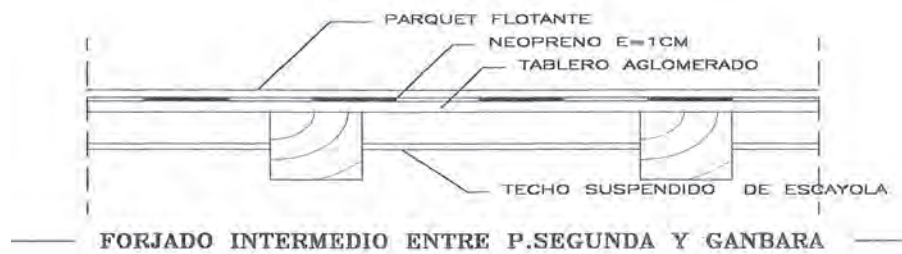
20. 2002 FORJADO EXISTENTE ENTRE 2ª PLANTA Y 3ª
